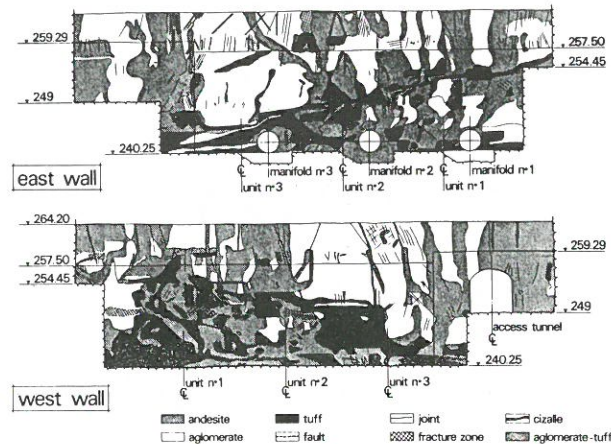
Sezioni geologiche in corrispondenza delle pareti Est ed Ovest della caverna
